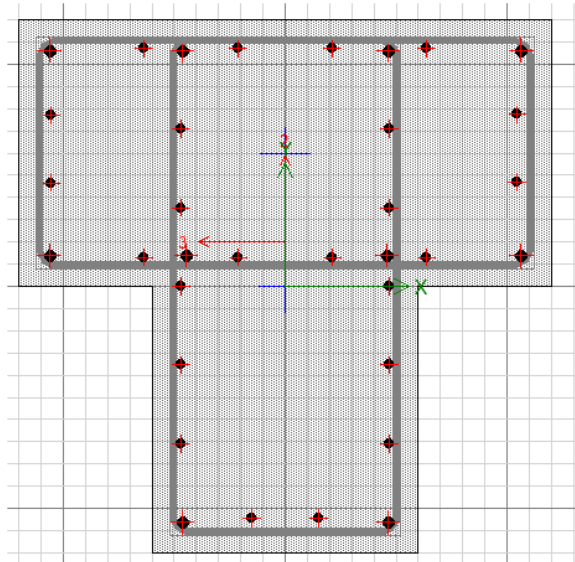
Columna en T 1.00x1.00x0.5m postensado.
